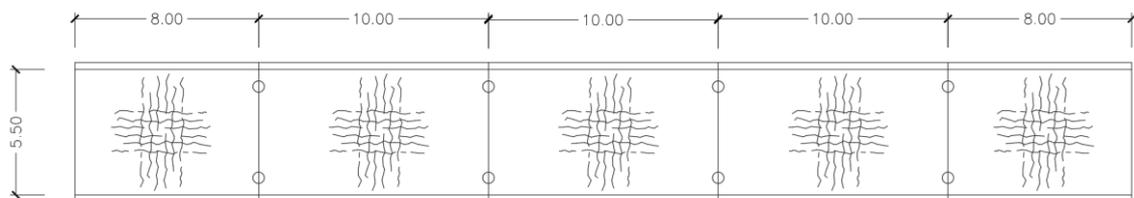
Fisuras en la cara inferior de la losa. Vista inferior del tablero.
